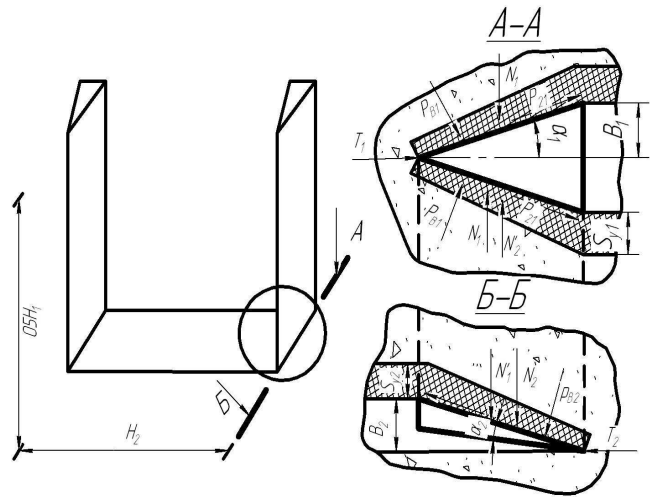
Розрахункова схема заглиблення вібраційного робочого органа вирізувального типу
